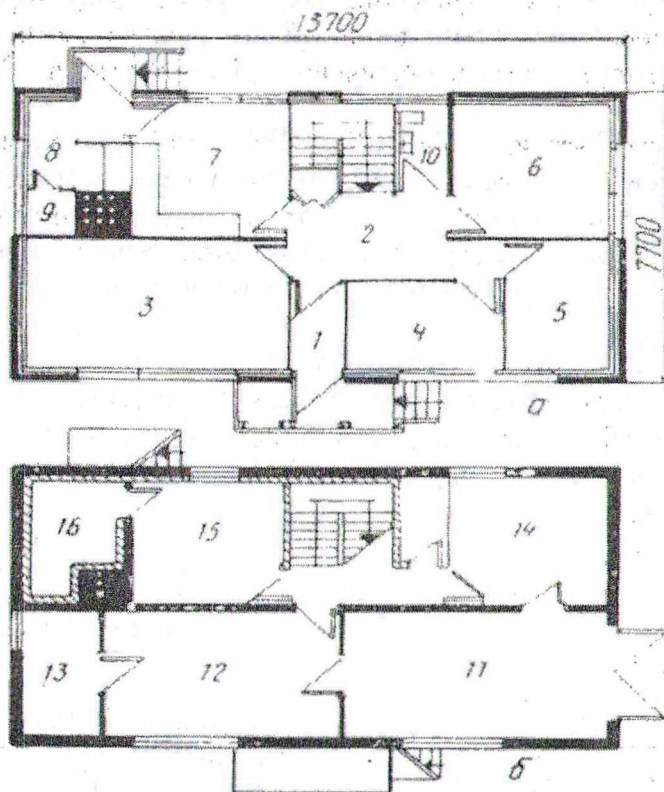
План жилого дома КСПИ-1141: а) план жилой части; б) план цокольной части. 1 – тамбур; 2 – прихожая; 3 – гостиная; 4, 5, 6 – спальни; 7 – кухня-столовая; 8 – кухня для приготовления корма скоту; 9 – склад; 10 – санузел; 11 – гараж; 12 – подсобное помещение (мастерская); 13 – котельная; 14 – помещение для овощей; 15 – ванно-прачечная; 16 – сауна
